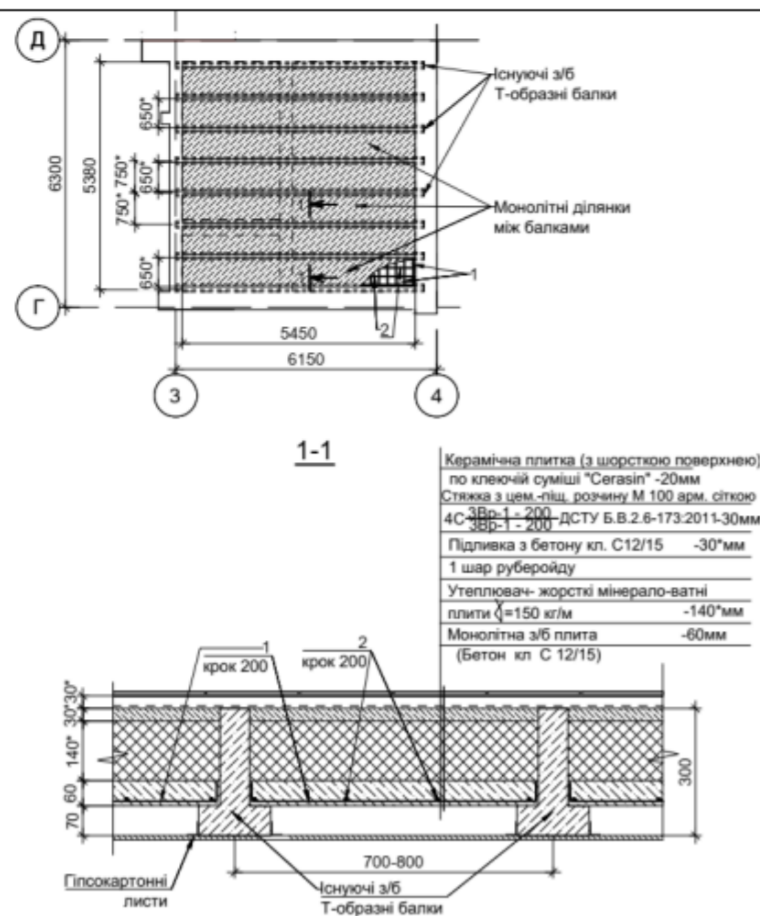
Фрагмент плану збірно-монолітного перекриття 1-го поверху по існуючим з/б Т-подібним балкам
